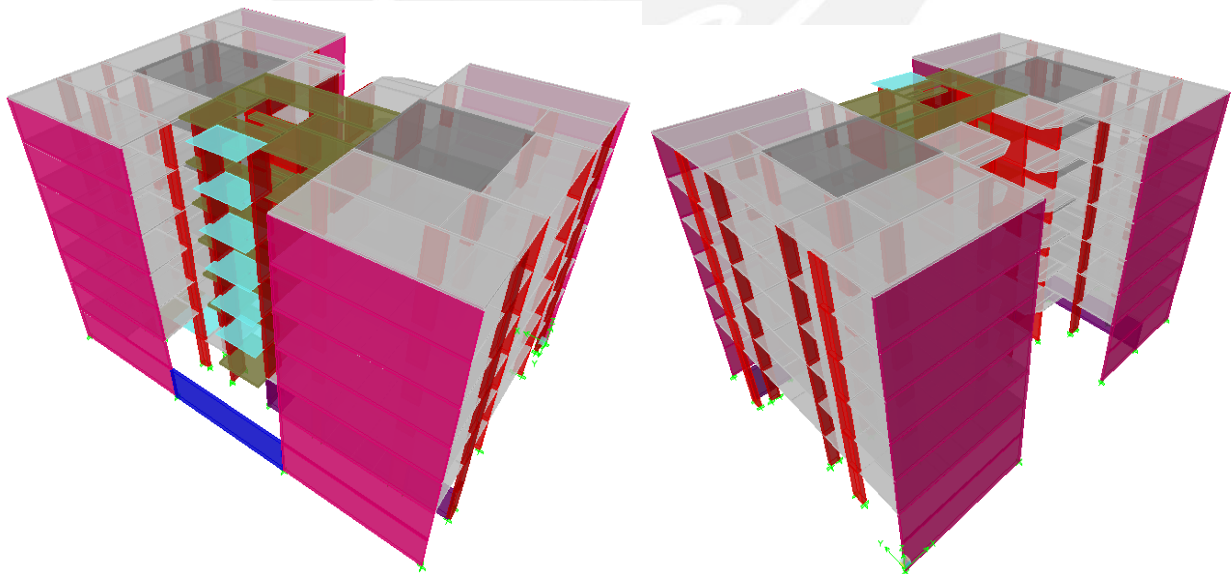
Vistas en 3D del modelo estructural.
